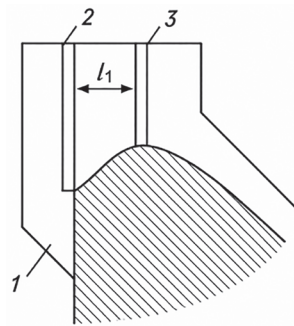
Esquema de una pila contiene volado (vista lateral).
